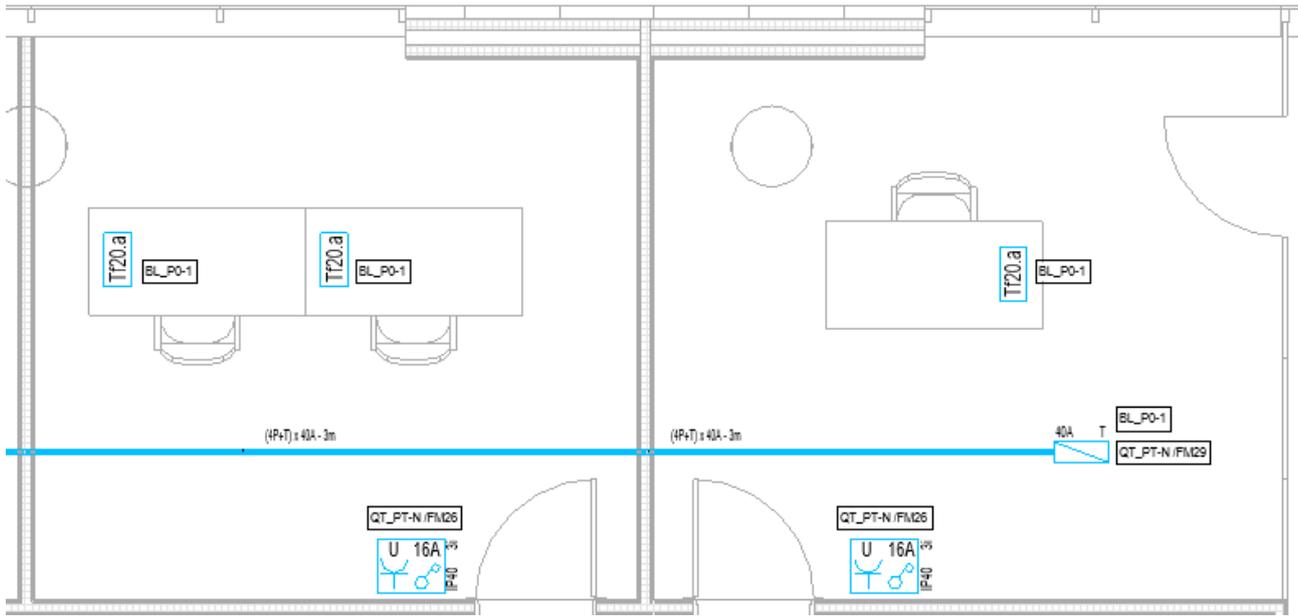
Vista in pianta dell'impianto di forza motrice con circuiti a dettaglio Basso
